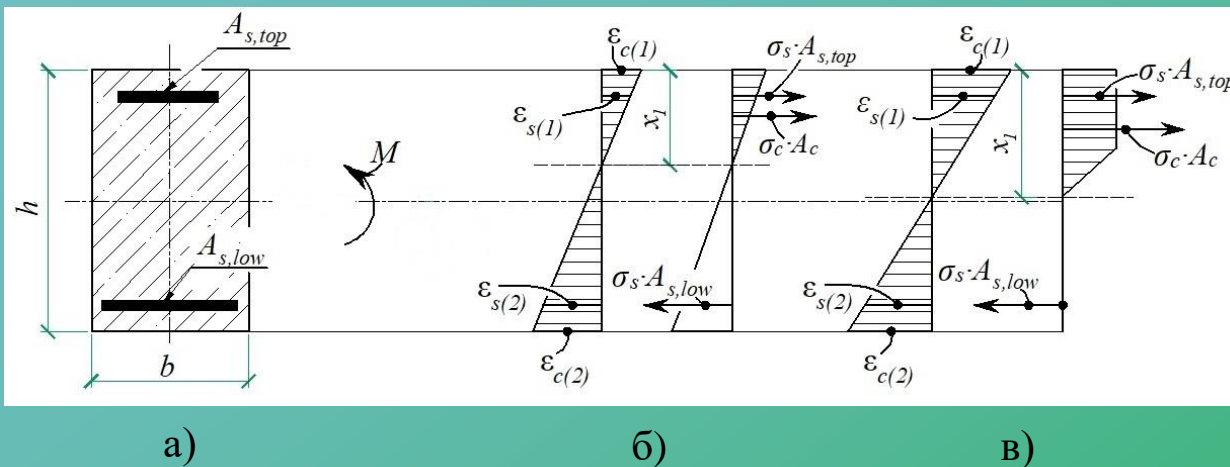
Схема зусиль і розрахункові схеми напружень та деформацій при плоскому згині у нормальному перерізі із подвійним армуванням:
